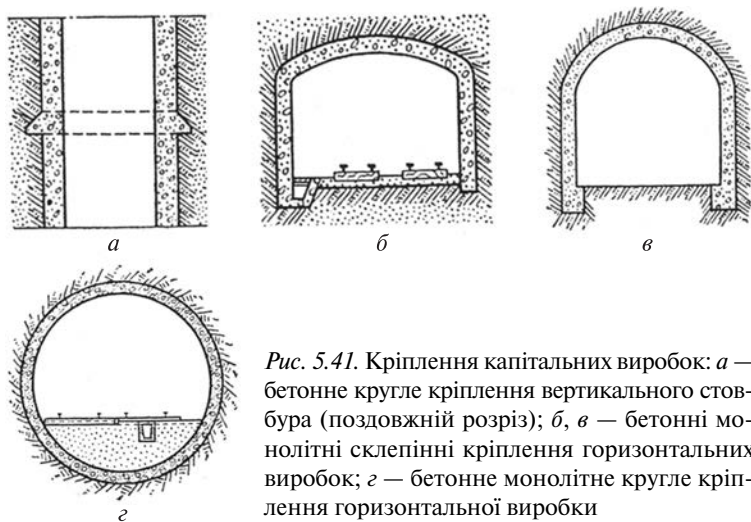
Кріплення капітальних виробок: а — бетонне кругле кріплення вертикального стовбура (поздовжній розріз); б, в — бетонні монолітні склепінні кріплення горизонтальних виробок; г — бетонне монолітне кругле кріплення горизонтальної виробки
